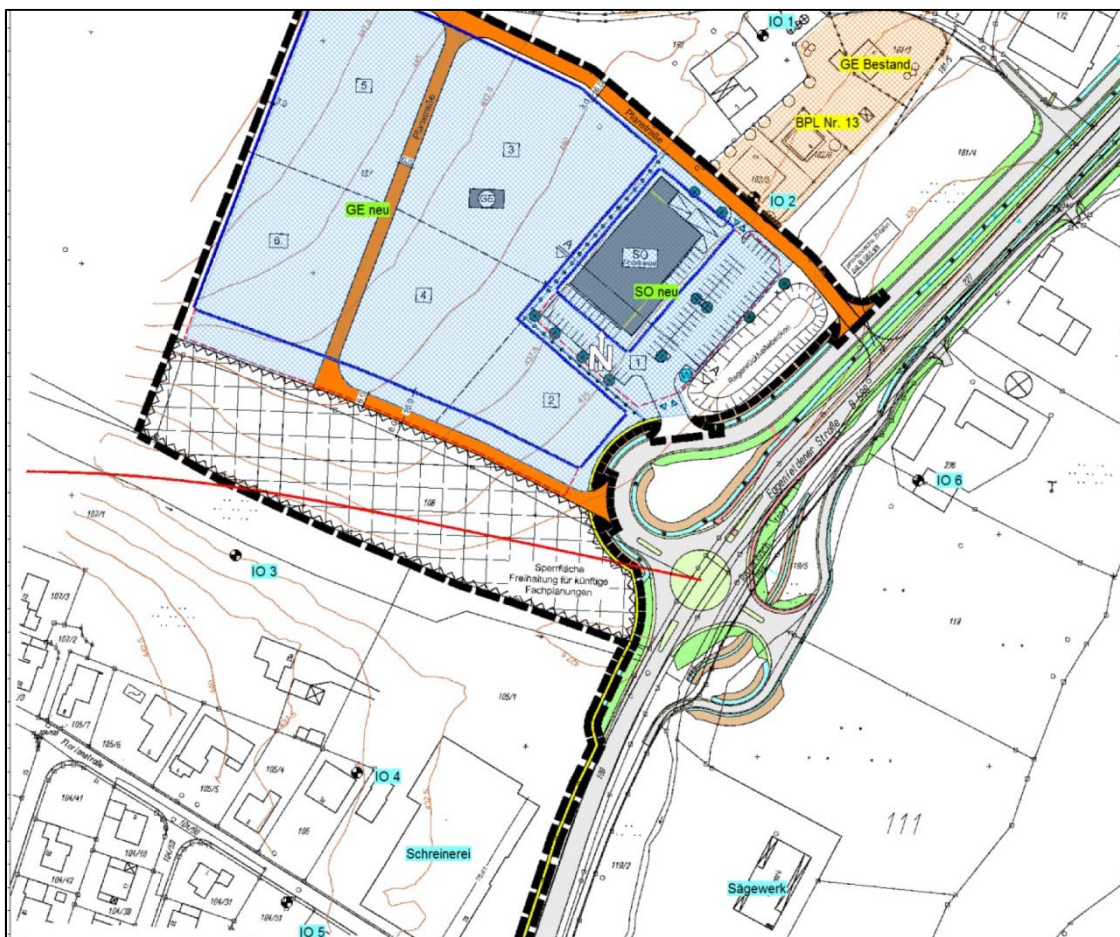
Lageplan mit Darstellung der maßgeblichen Immissionsorte gemäß /52/
